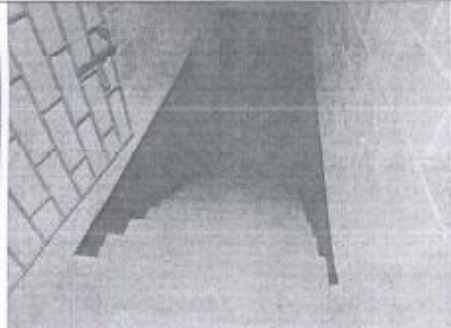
Se muestran las escaleras de descenso al sótano.
